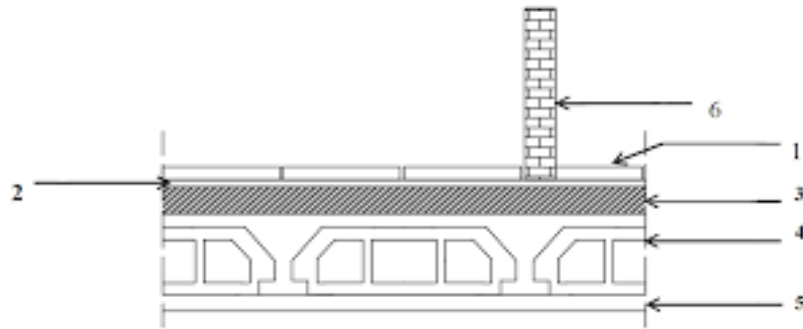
Coupe verticale du plancher d'étage courant + RDC
